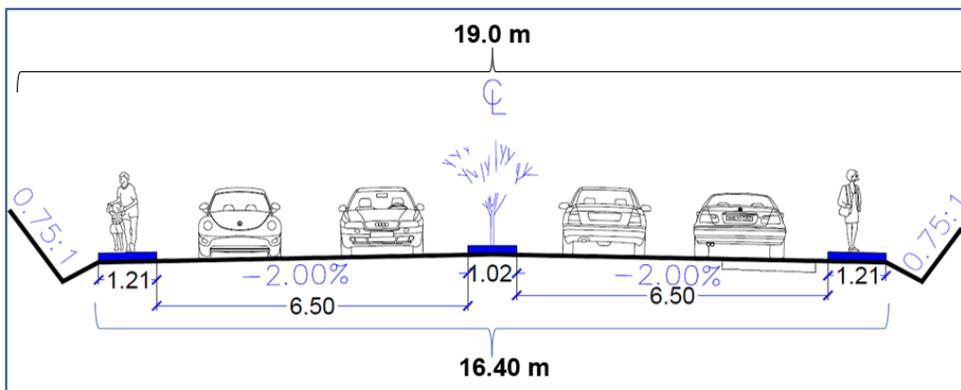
Sección tipo del proyecto de construcción del Boulevard
